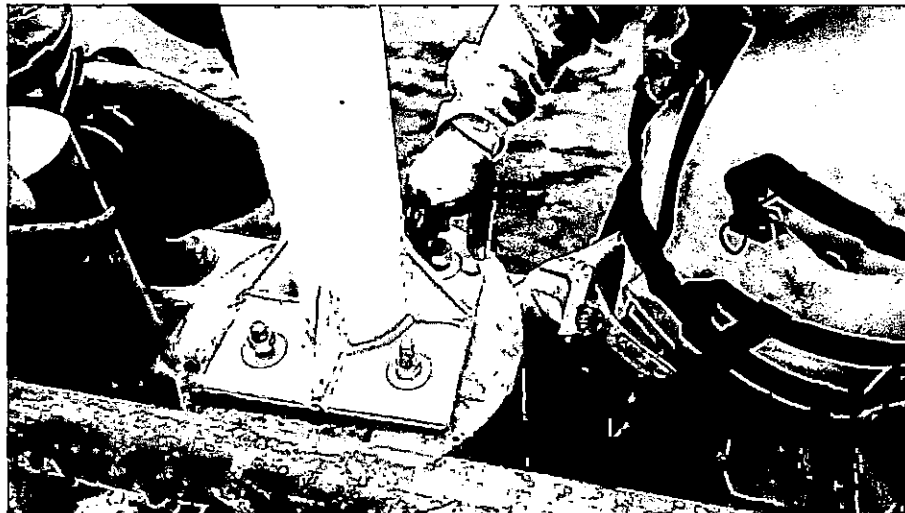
Fijación de las columnas metálicas en pedestales.
